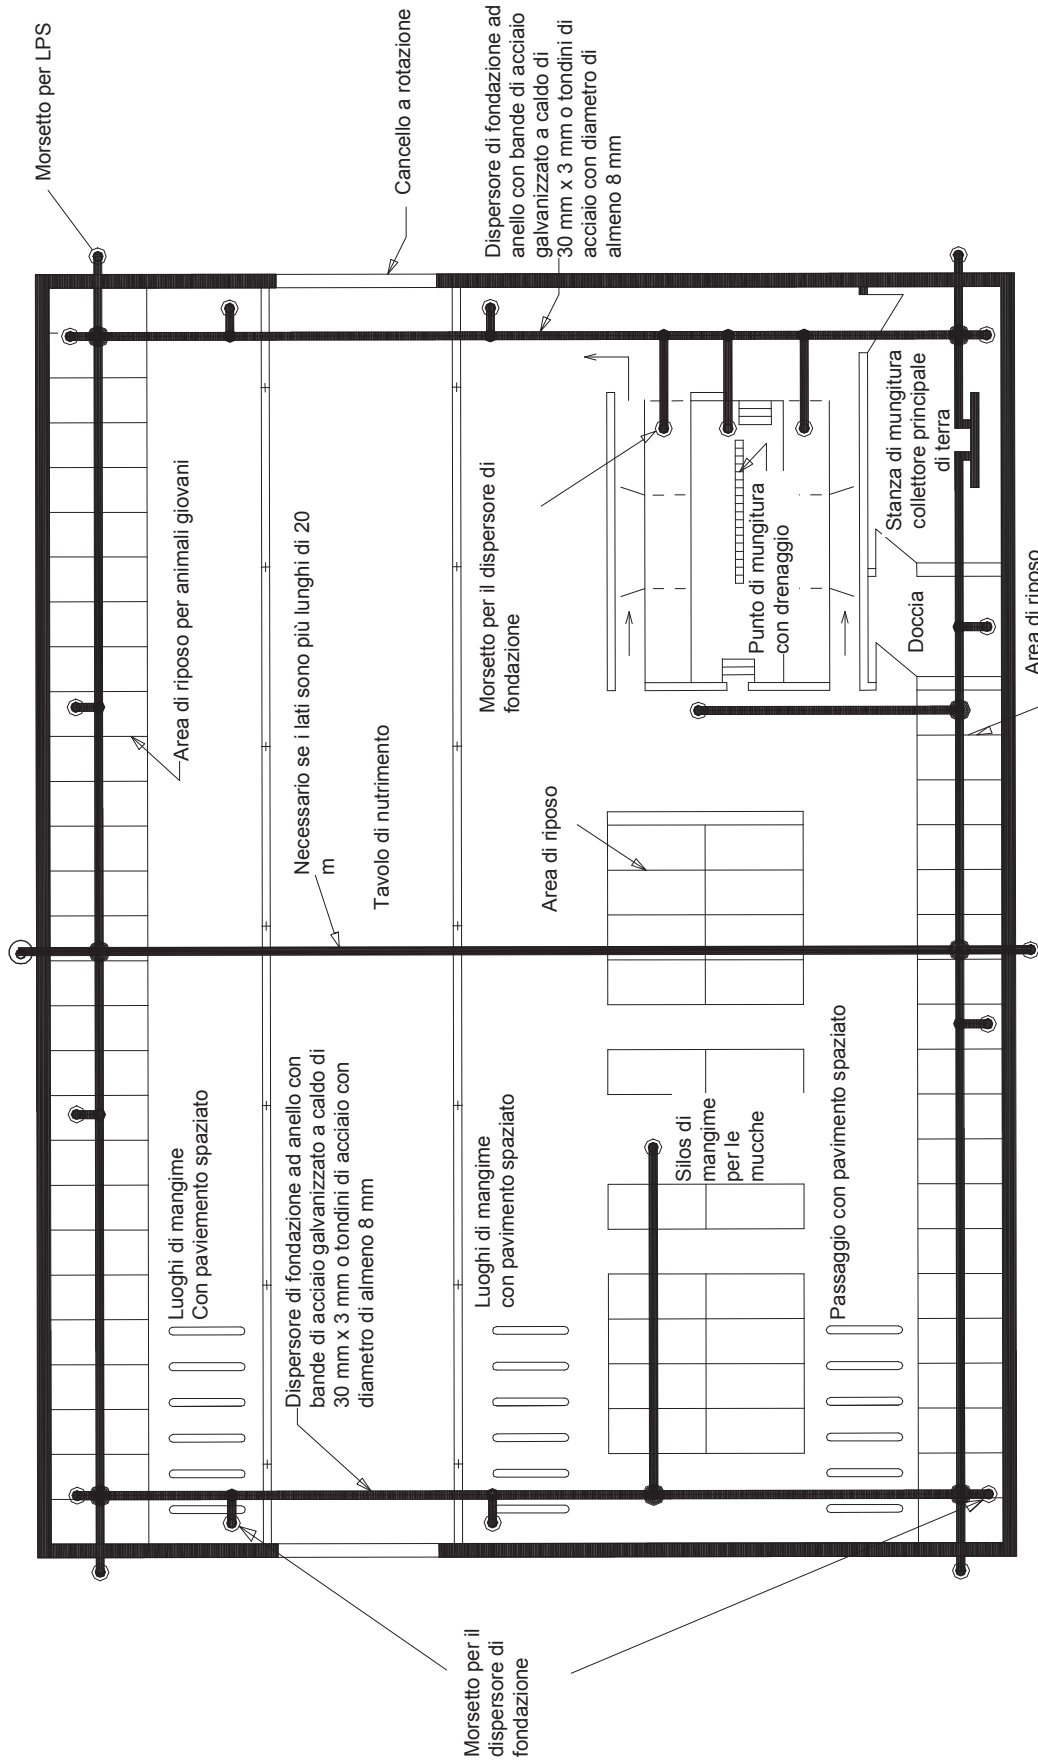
Esempio di disposizione del dispersore di fondazione in una stalla
